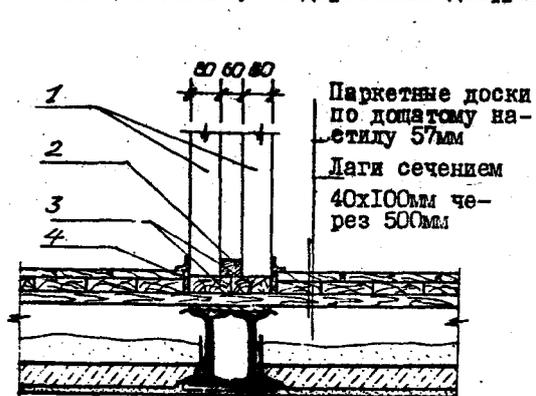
Междуквартирные гипсобетонные перегородки:
